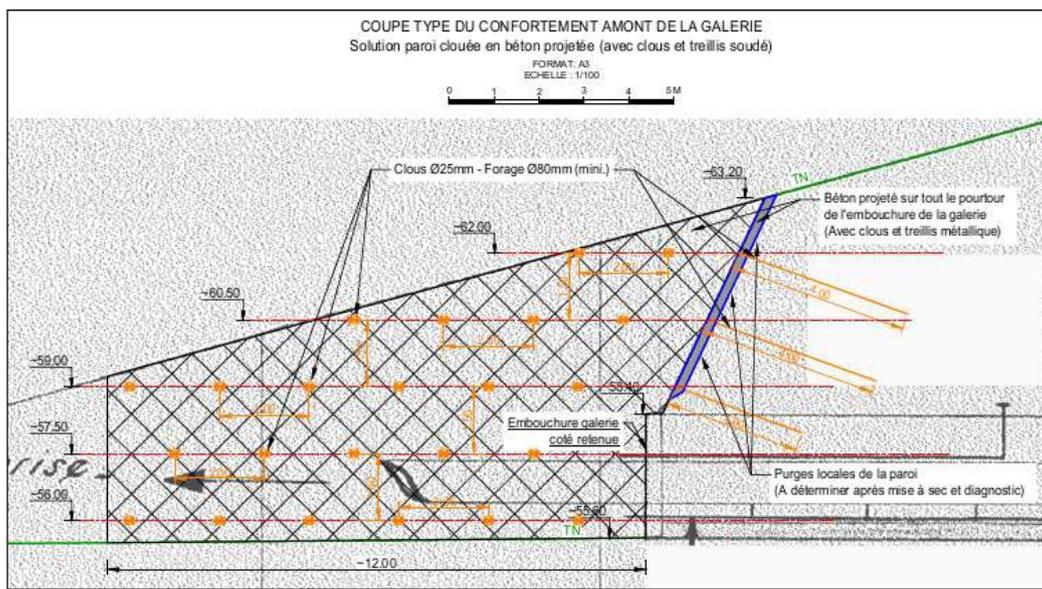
Principe - Coupe type de la paroi clouée (extrait plan PER-RCT-012)
